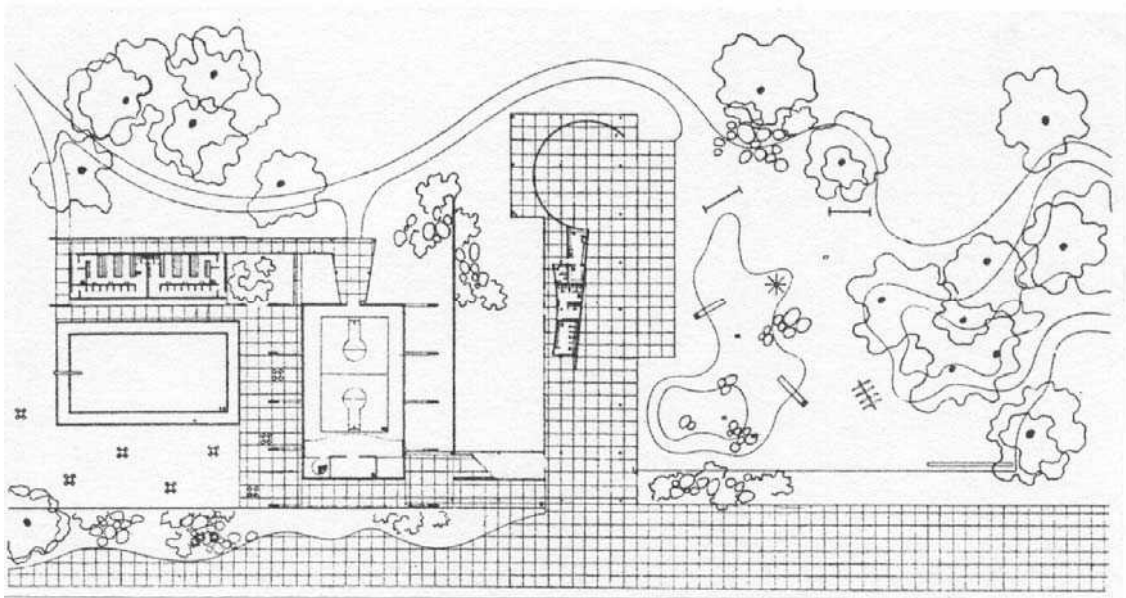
Planta do pavimento térreo da escola primária com ginásio
